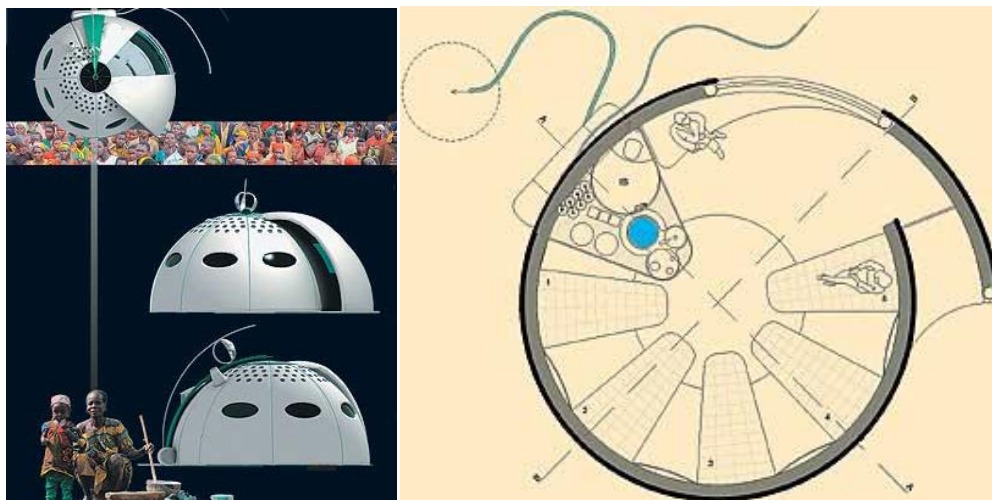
Elevação e Planta esquemática - habitação Campo de refugiados.
